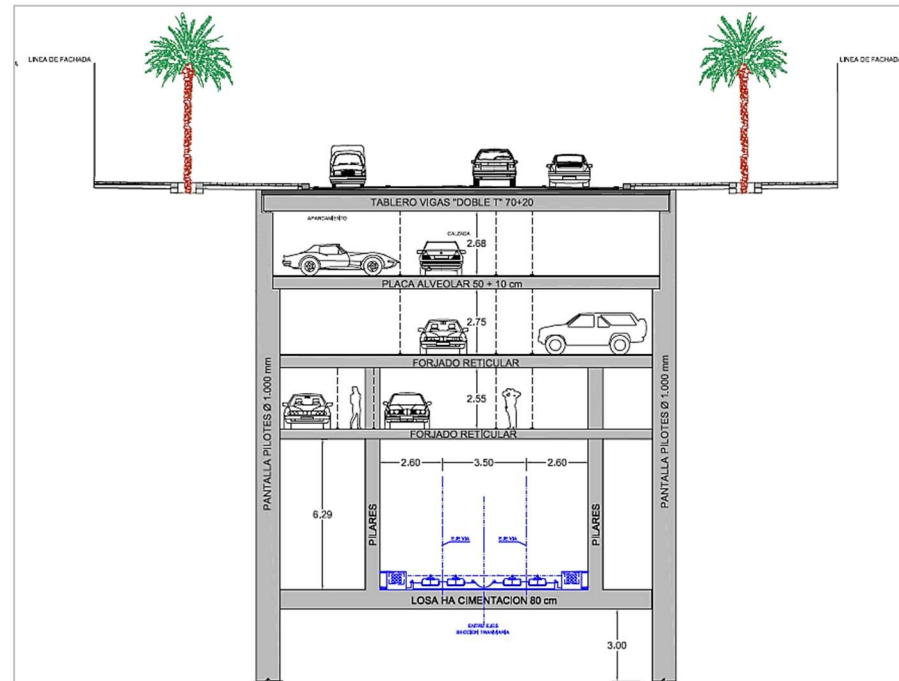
Sección transversal Tramo 0B: Avenida de la Estación. (Fuente: Proyecto Tramo 0B)
